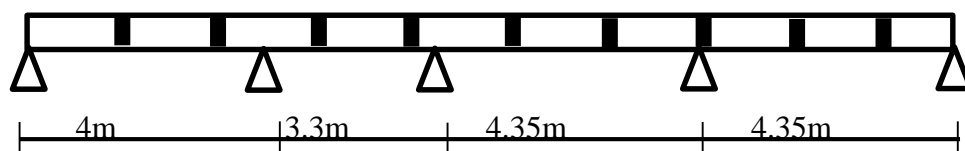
Schéma statique de poutrelle Type1 (4 travées)
